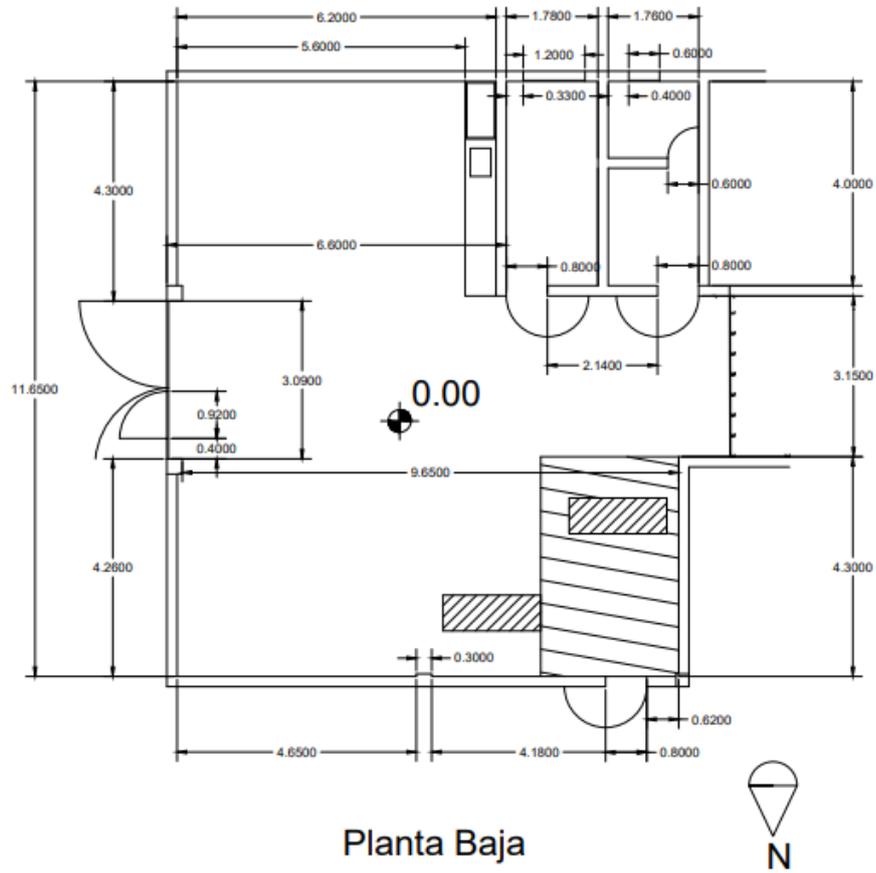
Plano de la Planta Baja del proyecto. Figura tomada de los planos oficiales del proyecto
